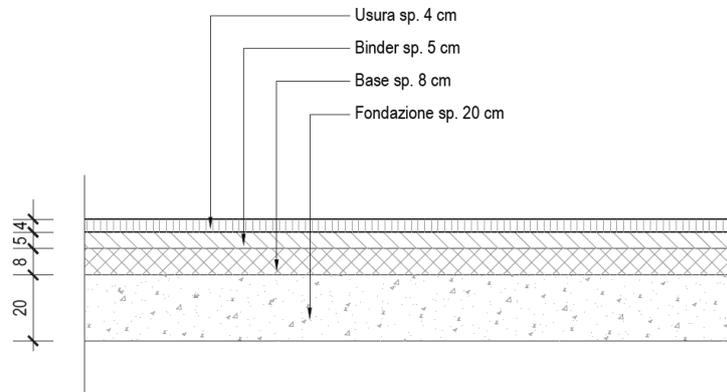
Dettaglio pacchetto di pavimentazione NV04
